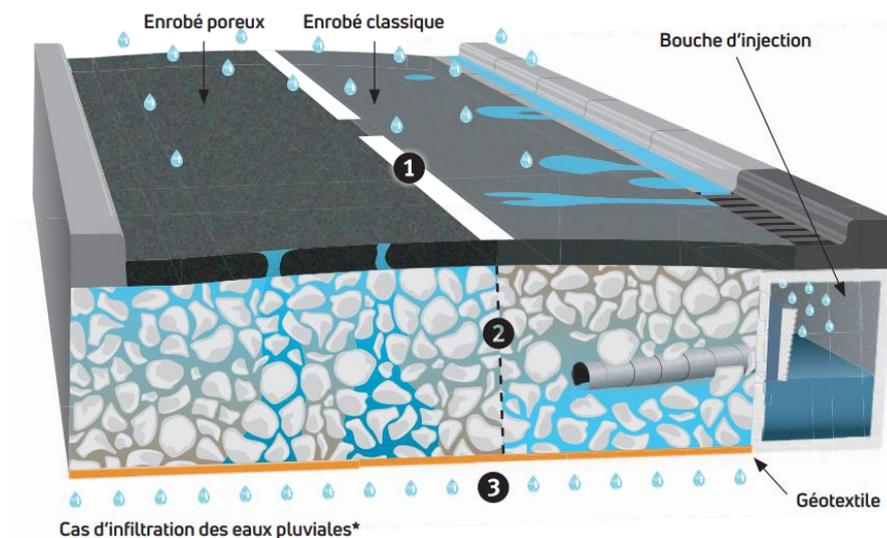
Schéma d'une chaussée à structure réservoir avec enrobé poreux (à gauche) et enrobé classique (à droite) dans le cas d'infiltration des eaux pluviales – ADOPTA
